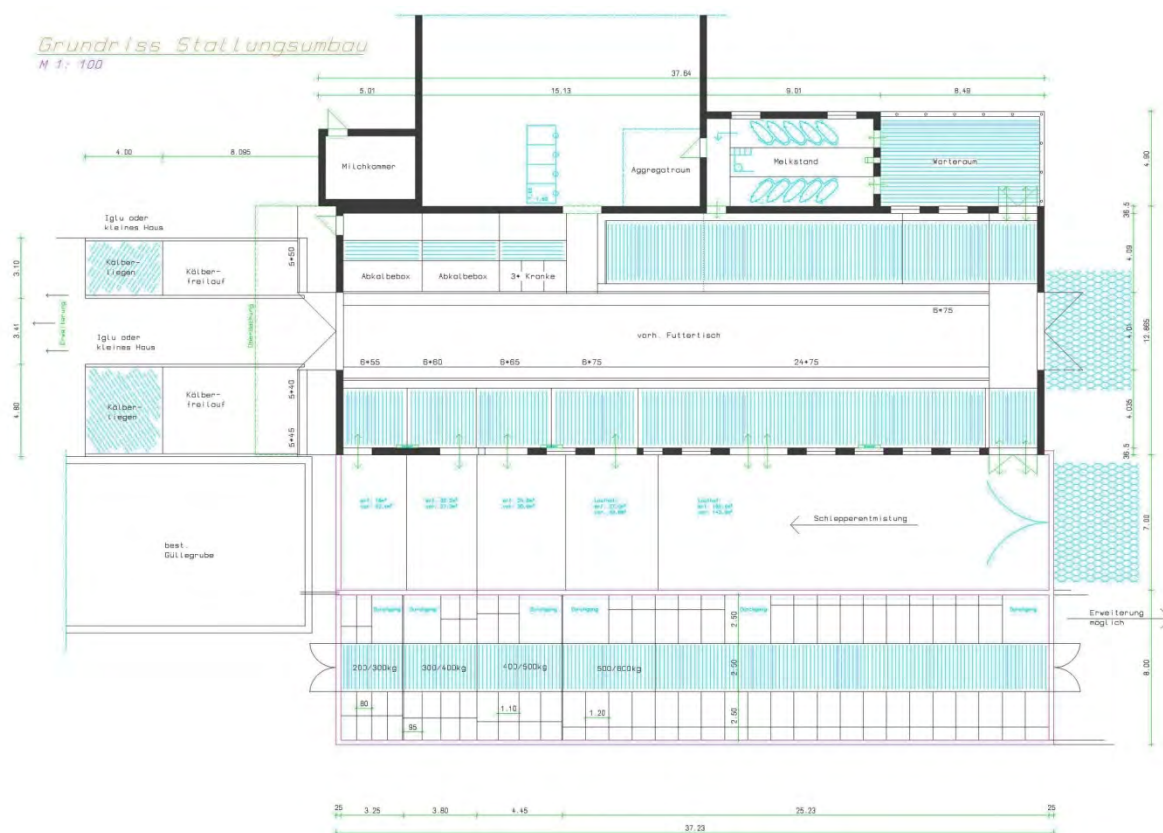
Grundriss Umbau Anbindestall mit separater Liegehalle
